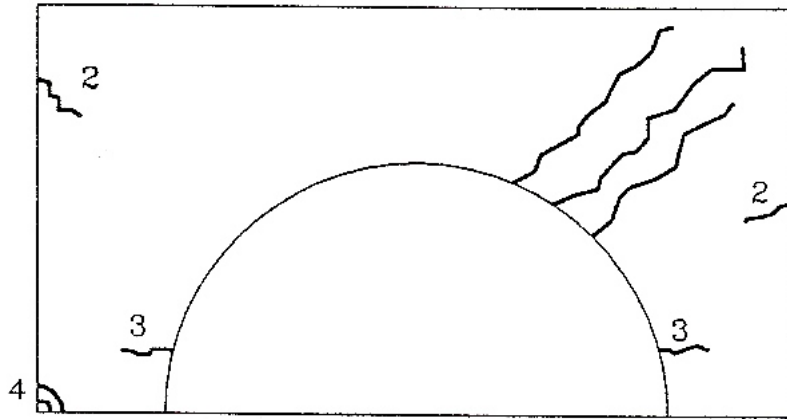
Tipo de agrietamiento en paneles de mampostería en arco.
